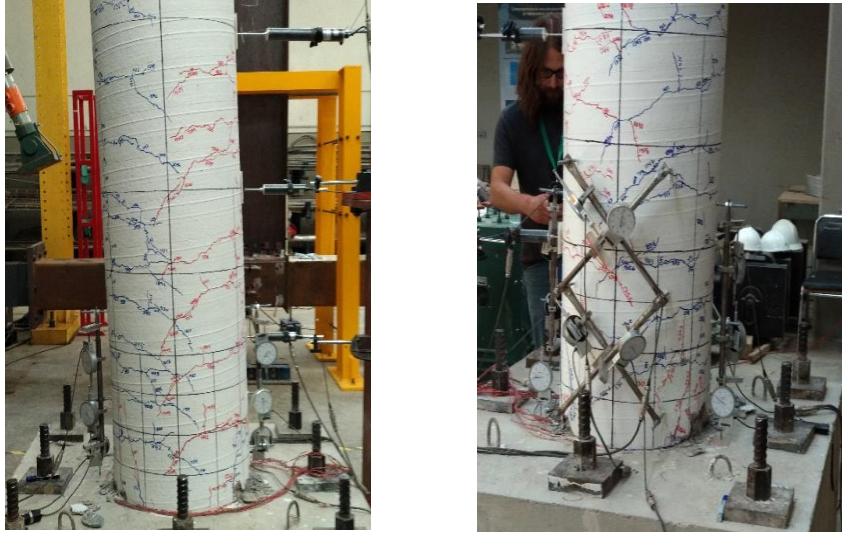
Patrón de grietas de flexión de espécimen MC-2
